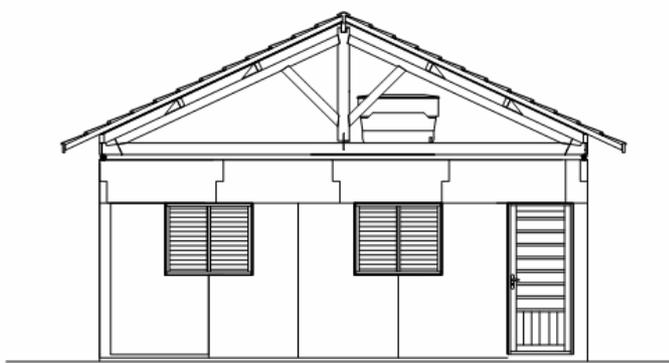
Fachada Frontal – Disposição das placas pré-moldadas
